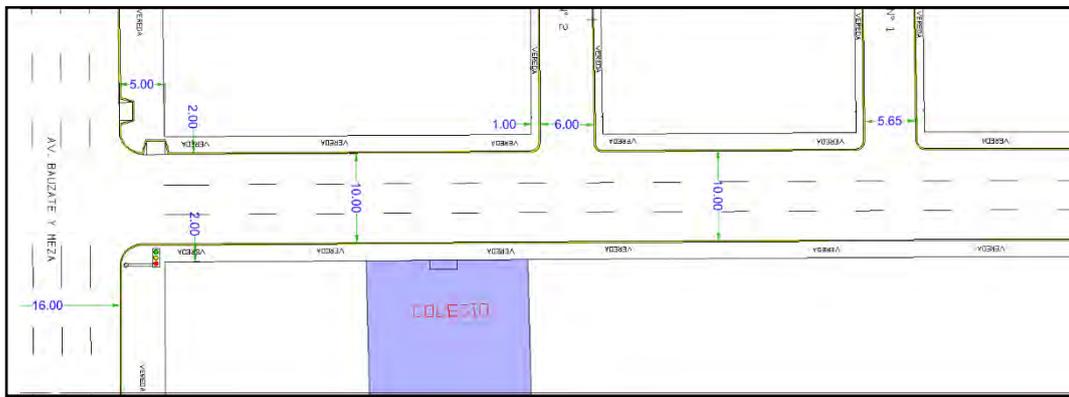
Vista en planta de situación actual en la Av. Cangallo cruce con Bauzate y Meza.
